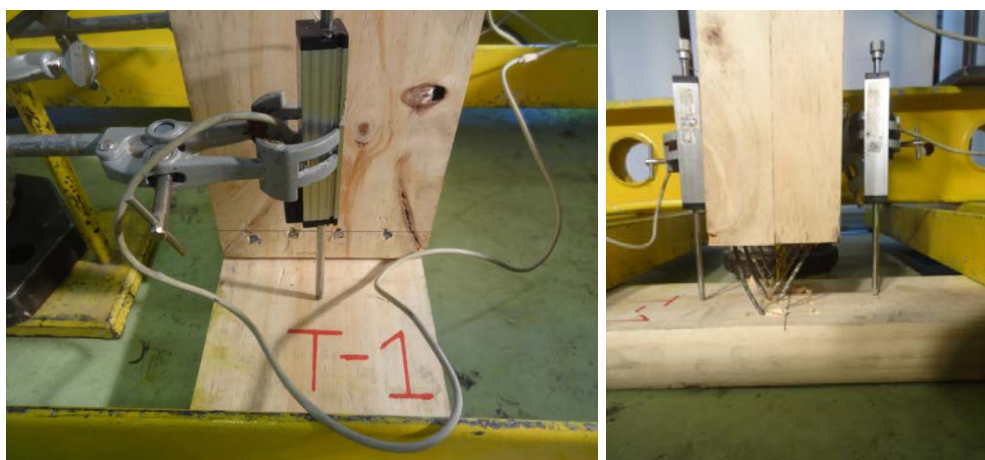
Conexión tipo lancero entre Pie Derecho y Solera durante el ensayo.
